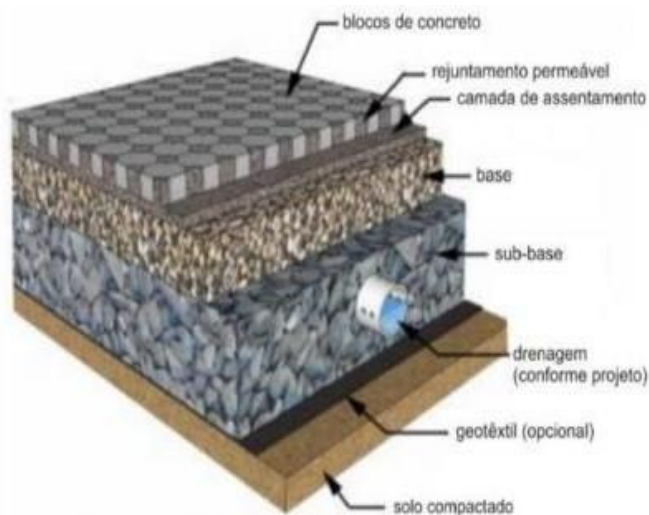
Pavimentação em concreto poroso com drenagem por meio de tubulação.
